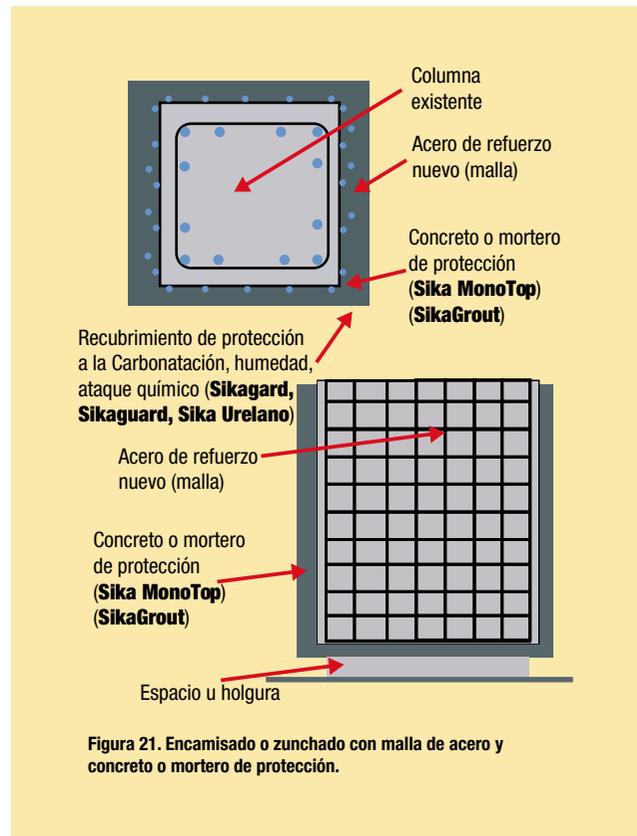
Encamisado o zunchado con malla de acero y concreto o mortero de protección.
